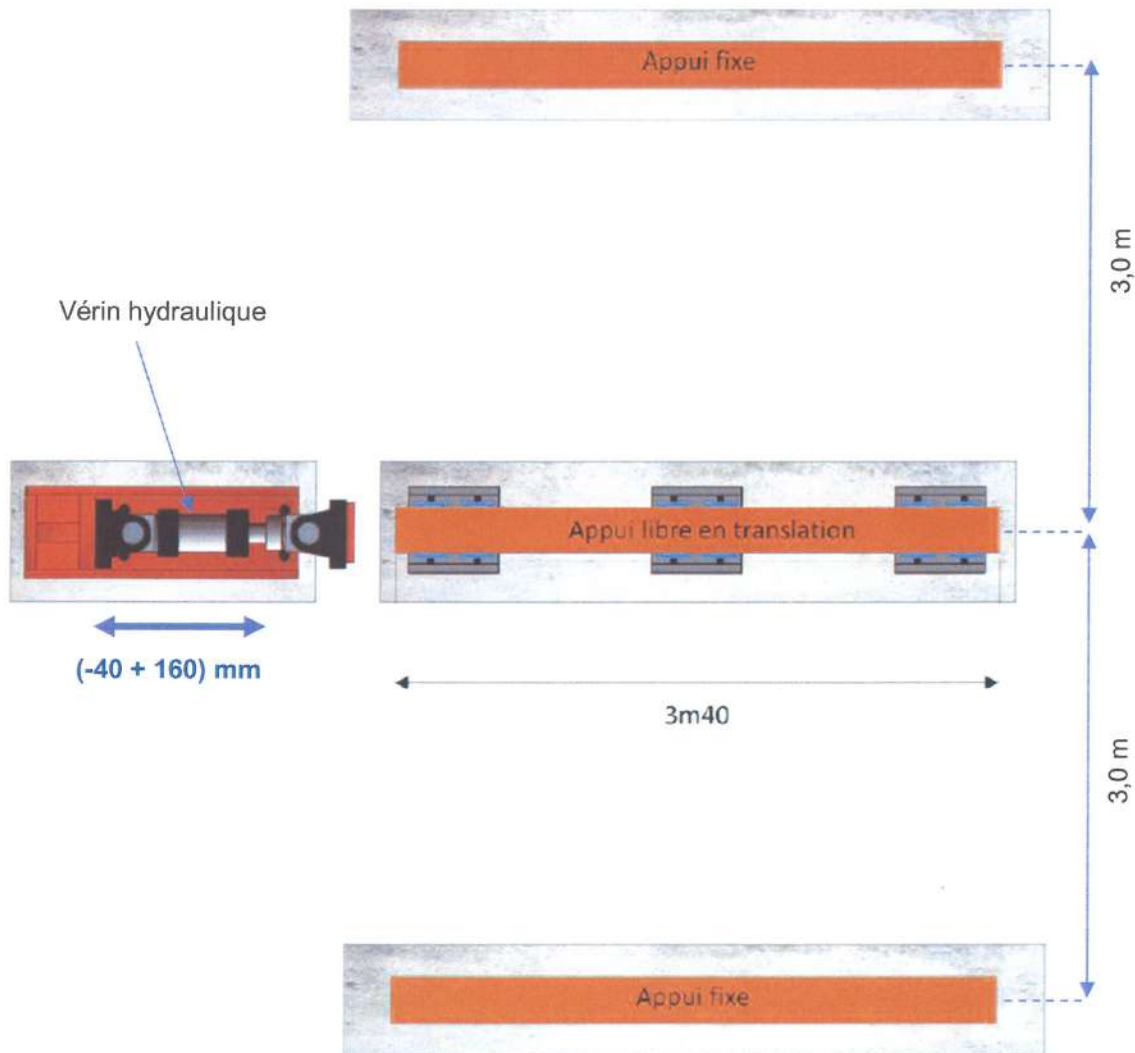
Schéma de principe du banc d'essais (Vue de haut)
